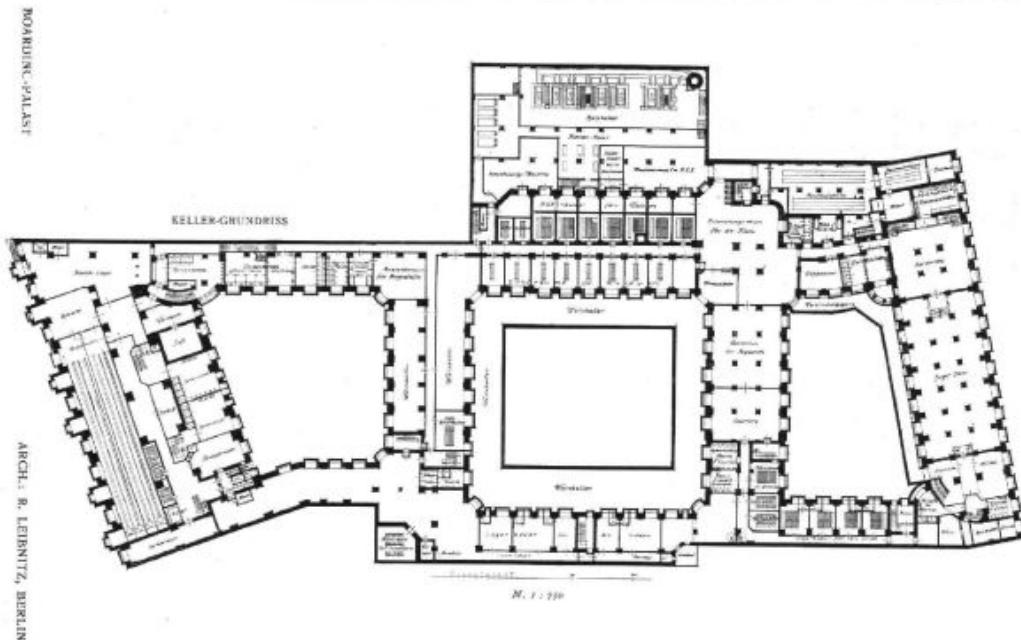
Robert Leibnitz, planimetria del Boarding Palast sul Kurfürstendamm, 1913 [da Berliner Architekturwelt Jg. 15, H.10, 1913]
